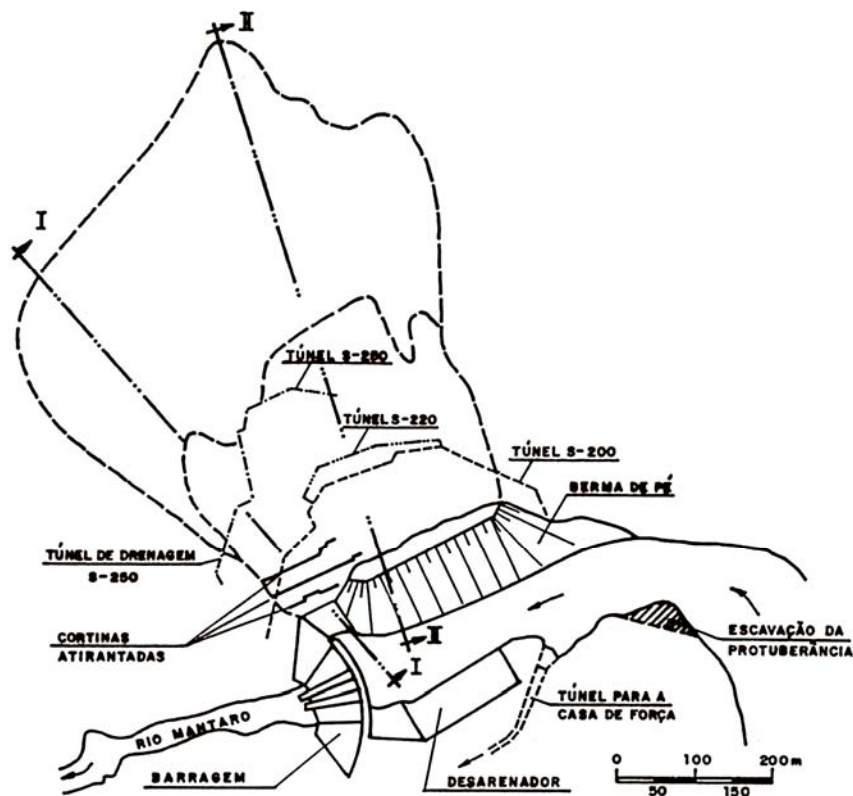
Planta geral das obras de estabilização do escorregamento junto à barragem de Tablachaca (Yassuda, 1988).
